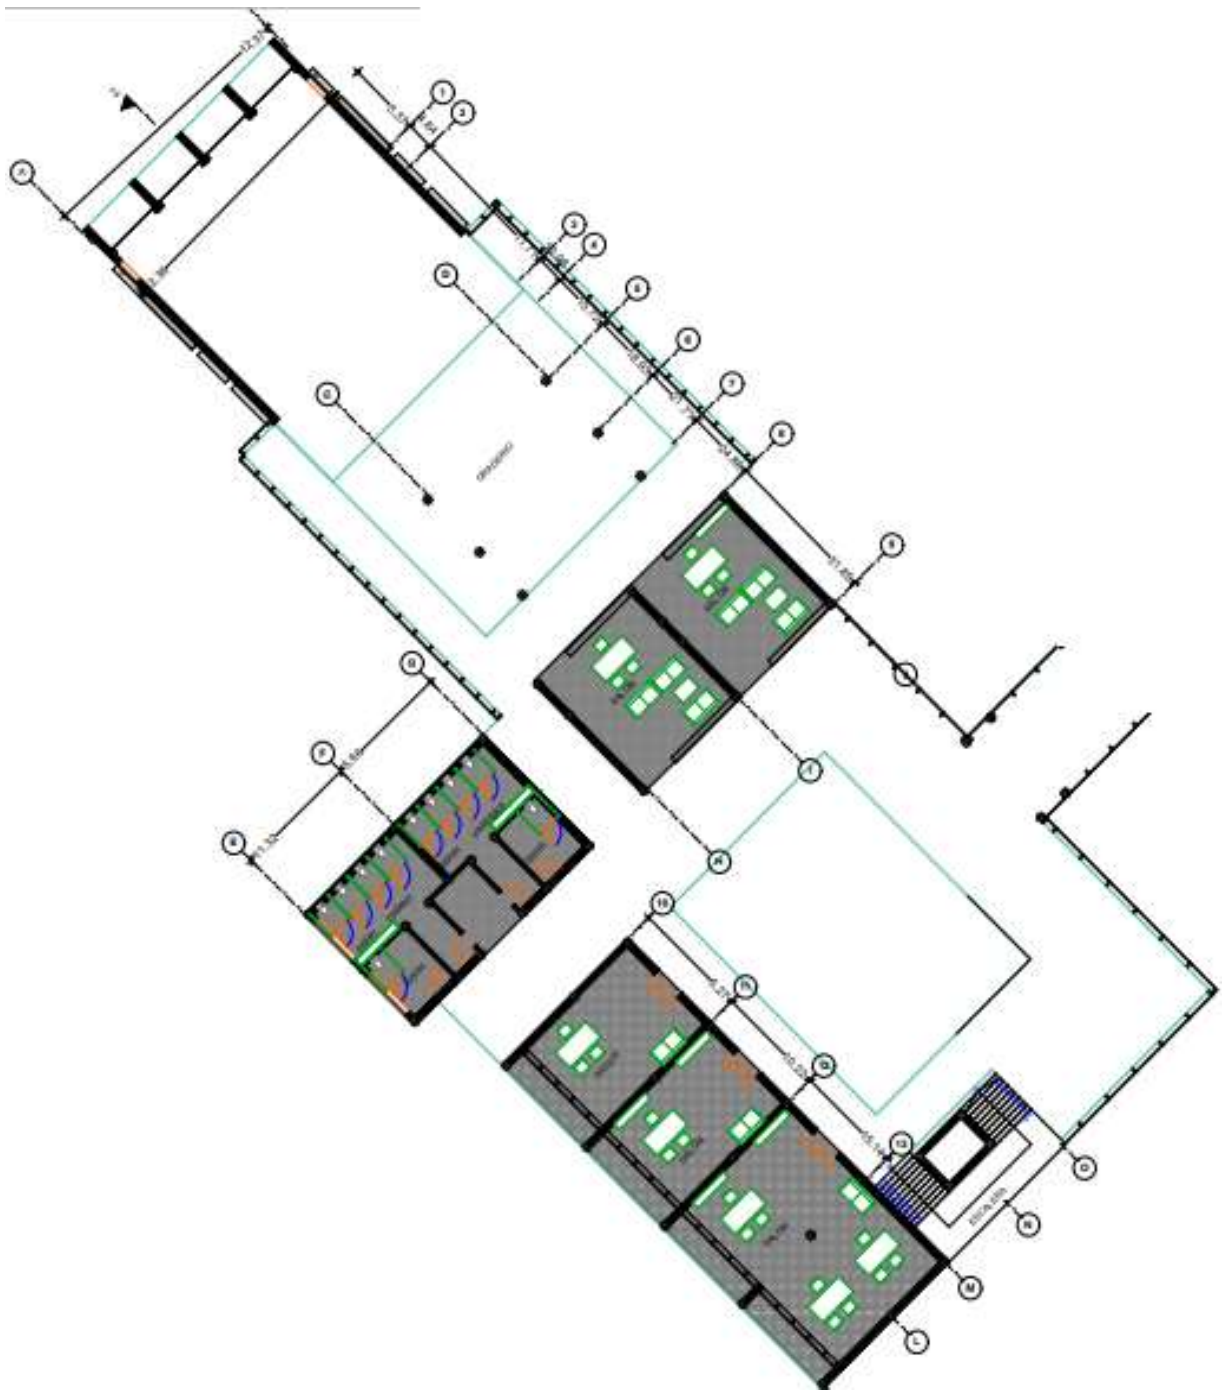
Plano en planta del Segundo Nivel – Primer Bloque
